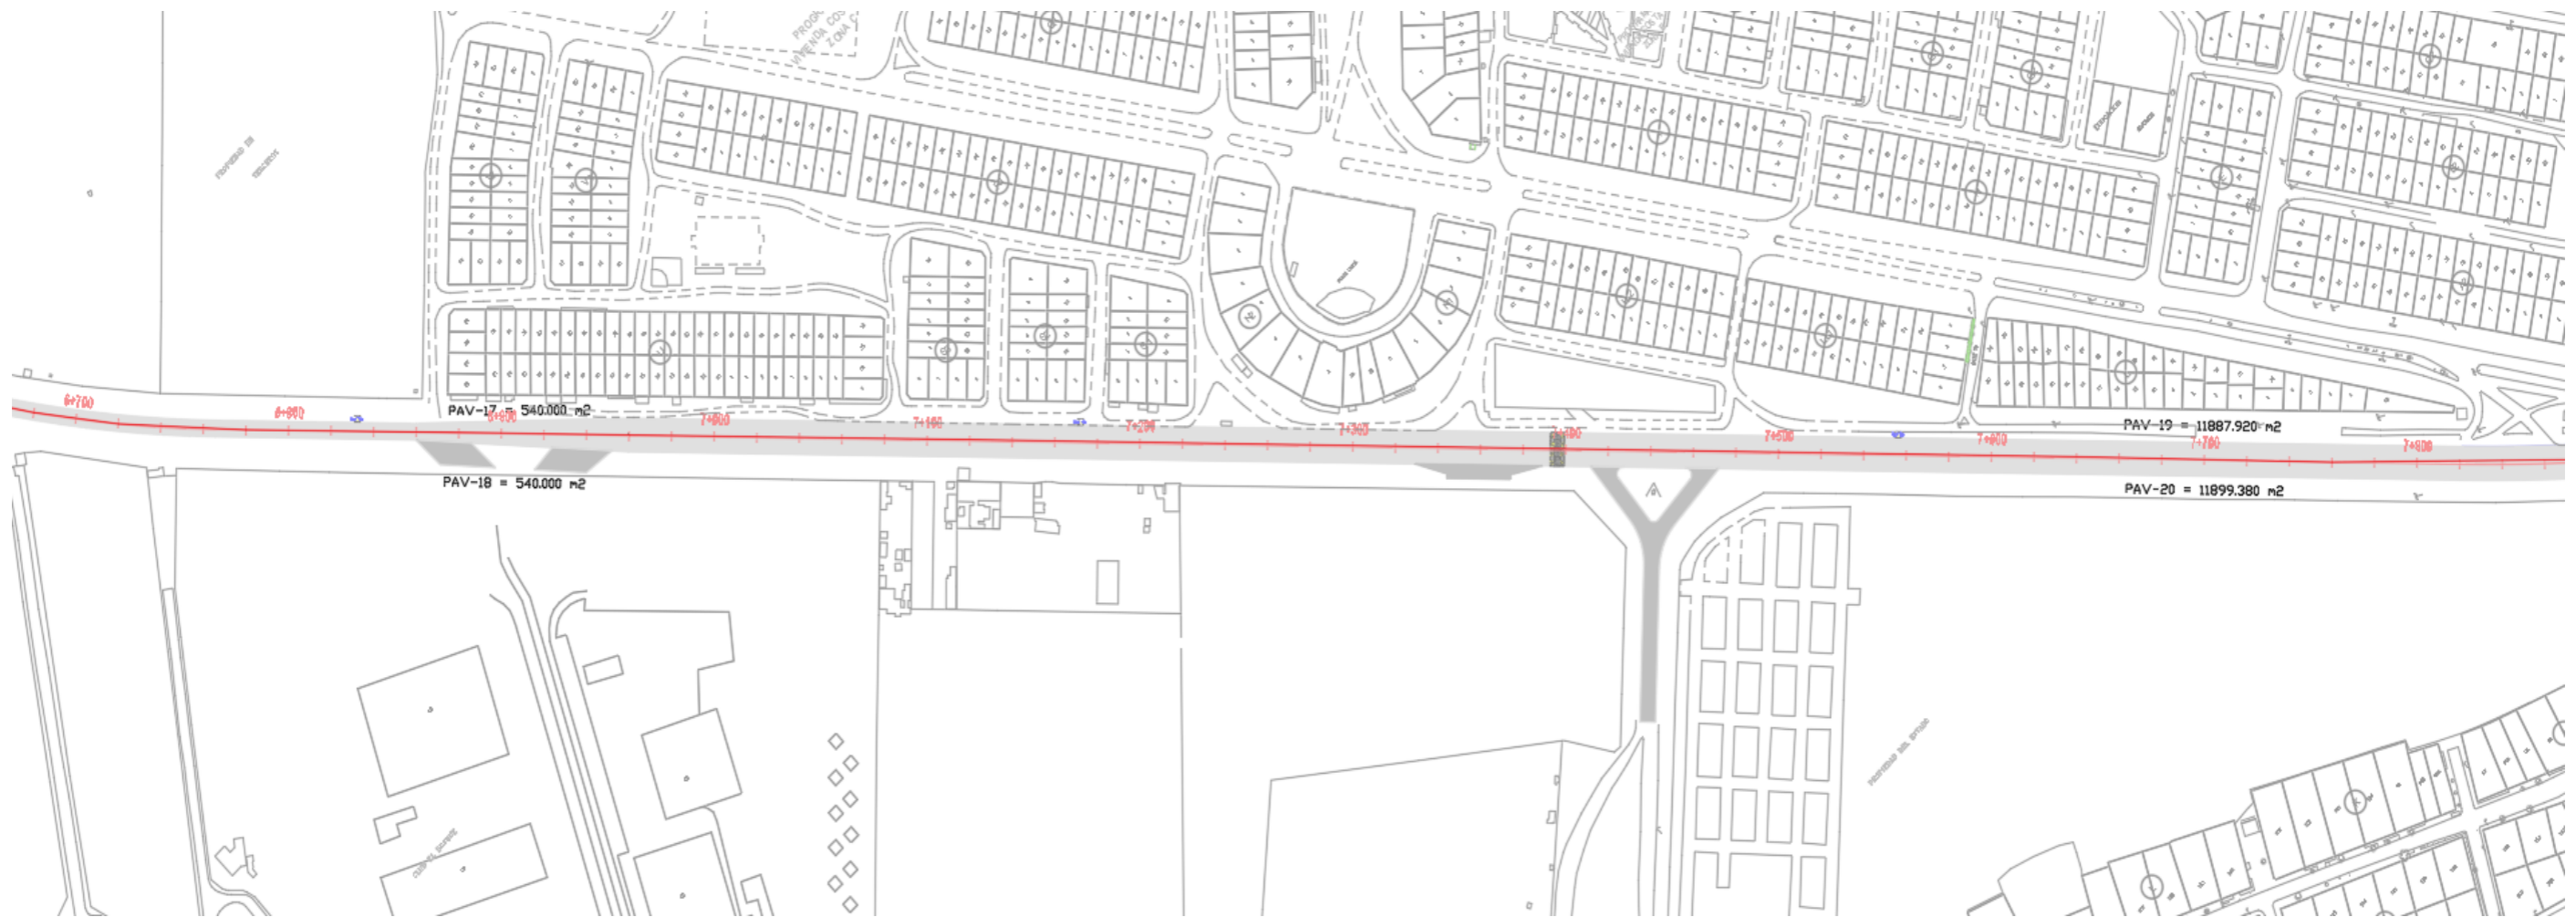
Plano Construcción Vía entre la Progresivas 2+600 – 3+900
